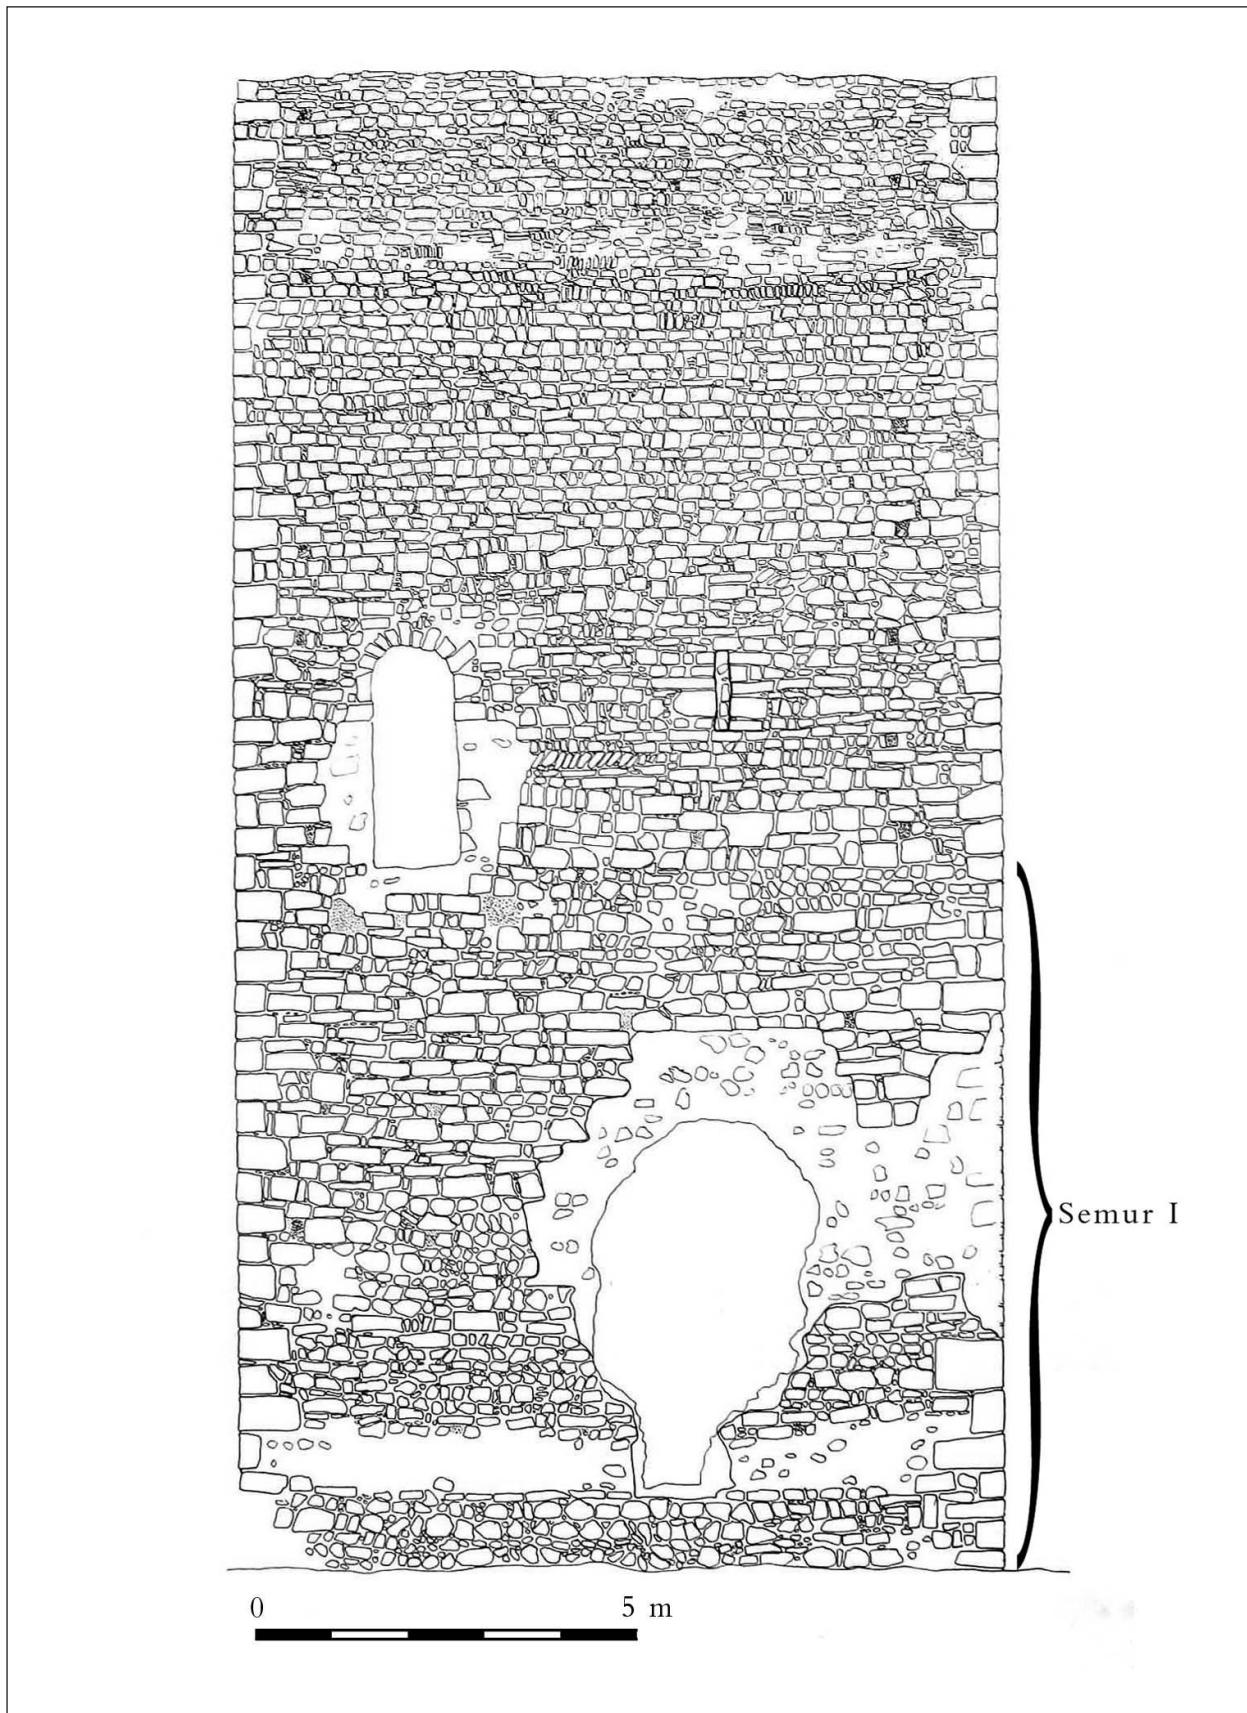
Semur-en-Brionnais, relevé pierre à pierre de la façade est (CeCaB, 2004, dessin J. Vallet).
